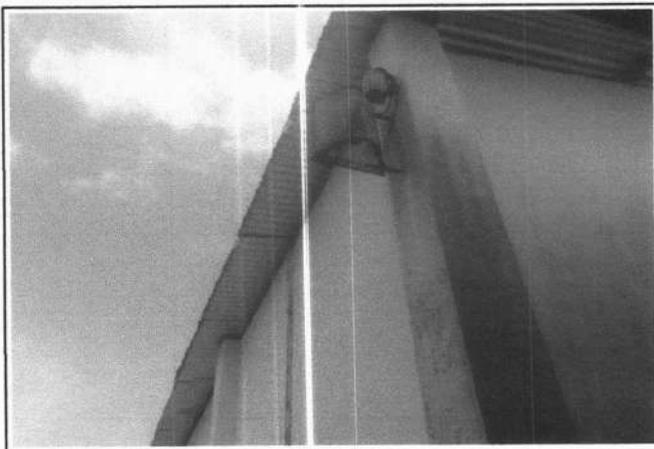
REVISÃO DE TELHADOS METÁLICOS
